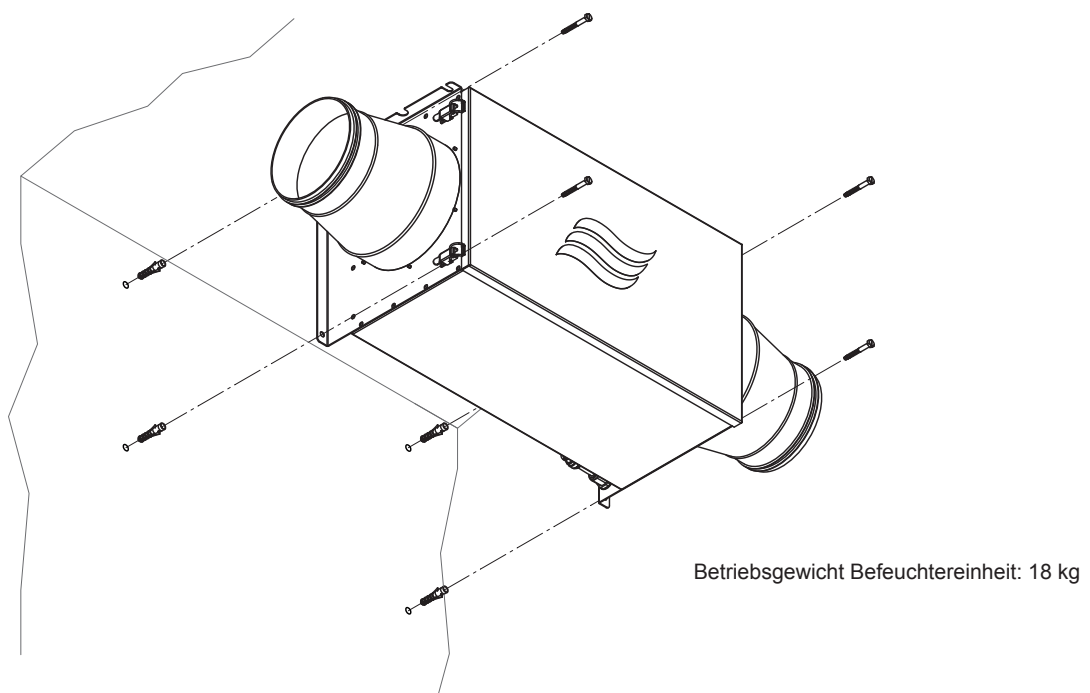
Befeuchtergehäuse an der Wand befestigen
